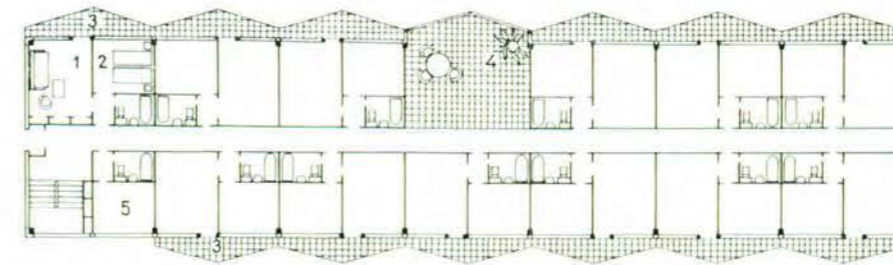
Wohnblock eines Altenheimes für 42 Personen Grundriß
